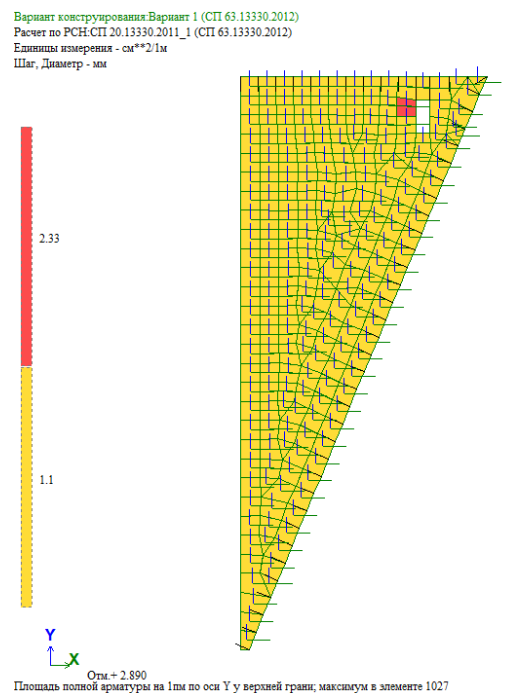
Армирование верхней зоны монолитного участка по оси Y
